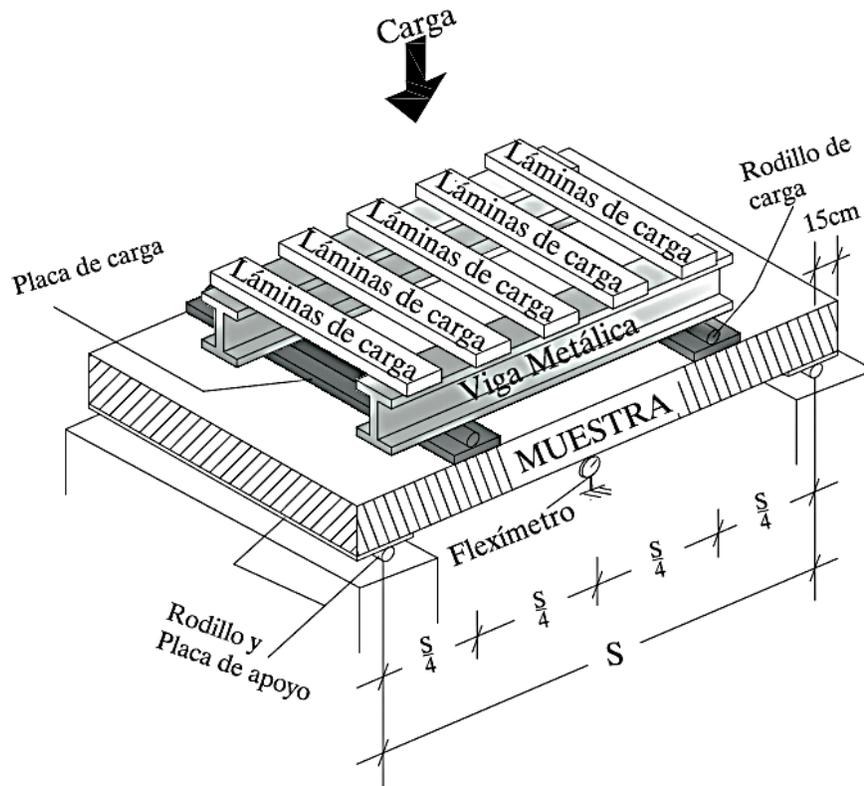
Ensamblaje del Equipo para el ensayo a Flexión (Carga Transversal-Muestra Horizontal).
